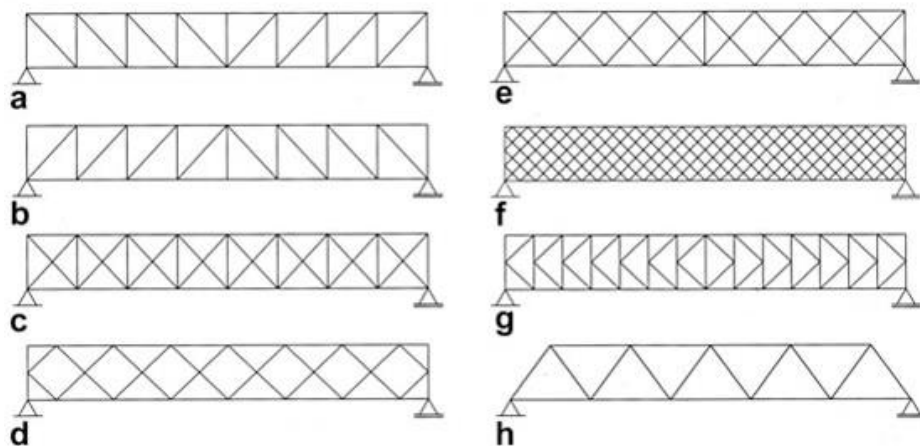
Imagen. Ejemplos de vigas de celosía. Fuente: www.arquitecturaenacero.com
